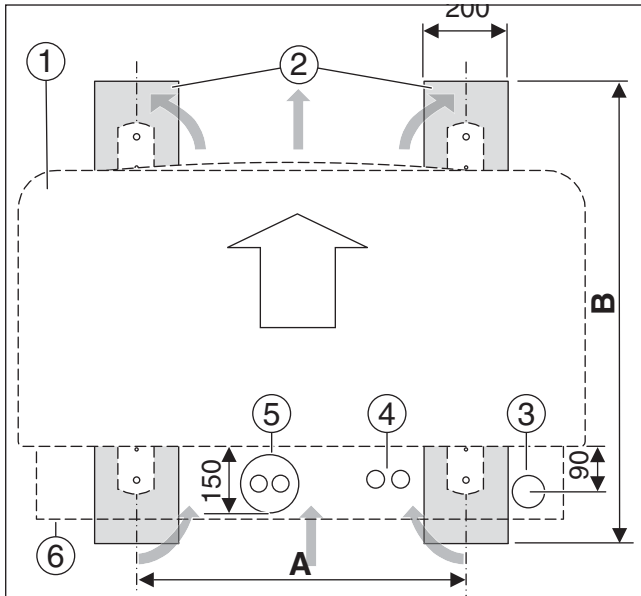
Lage der Fundamente und Rohre (SAO ...-2)
